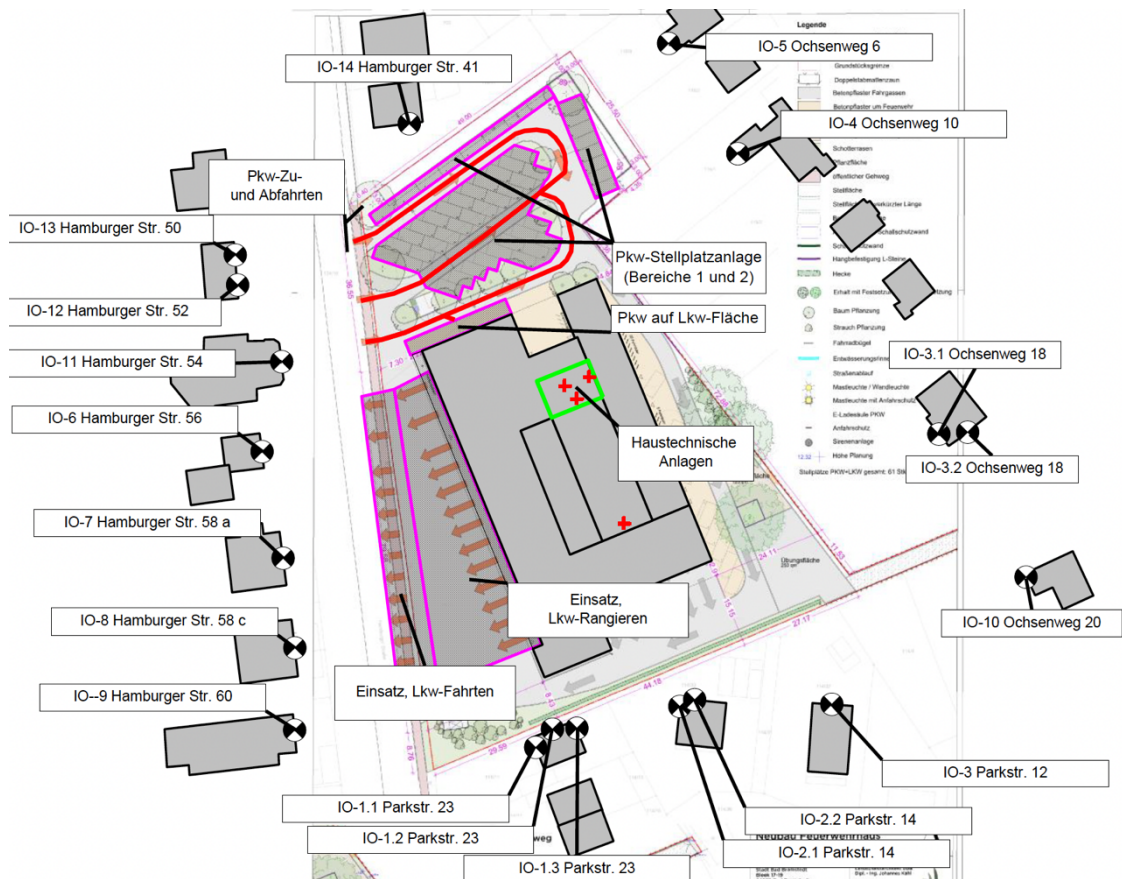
Lageplan mit den maßgeblichen Immissionsorten (IO) im Einsatzbetrieb,
